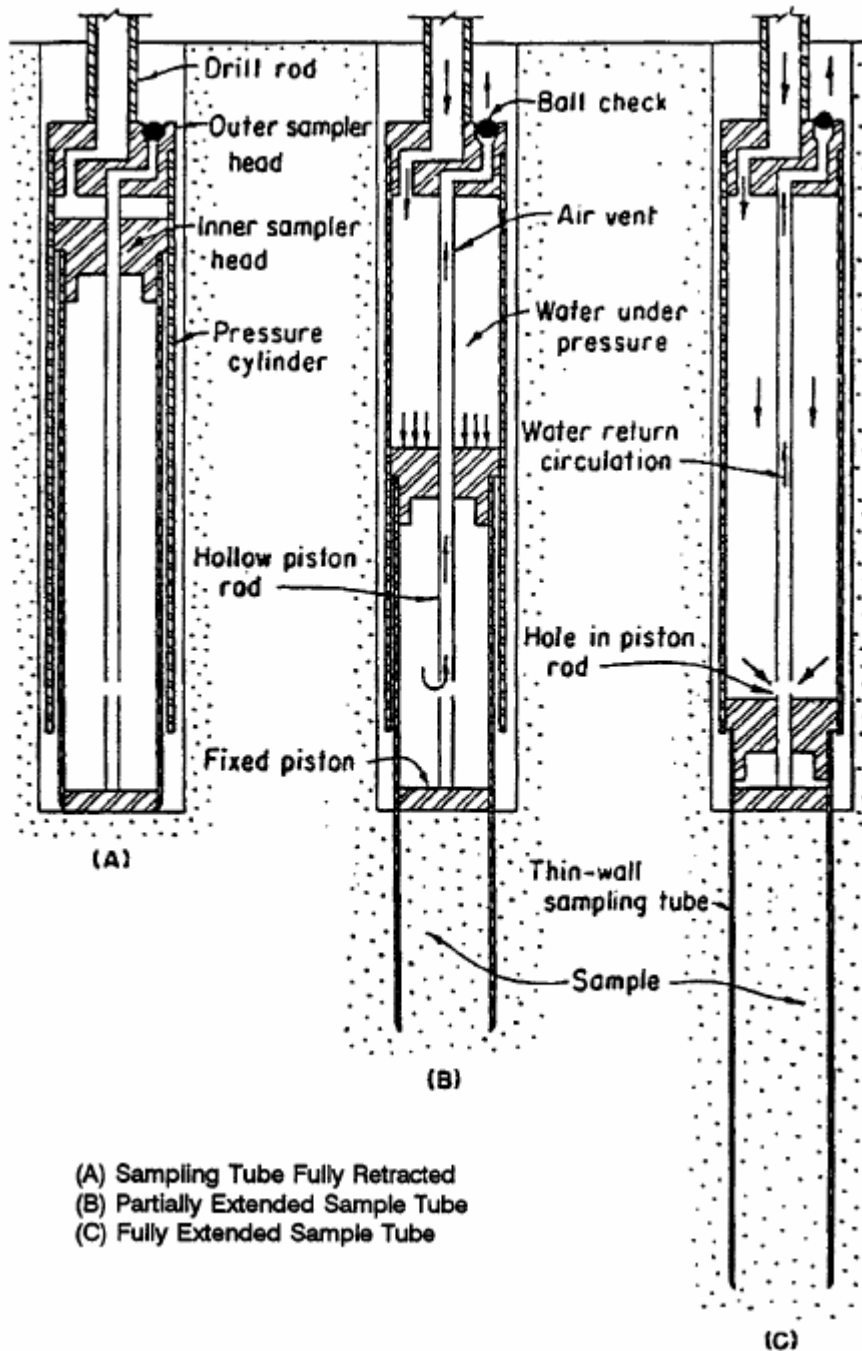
Préleveur hydraulique à piston en opération (ASTM D 6519)
